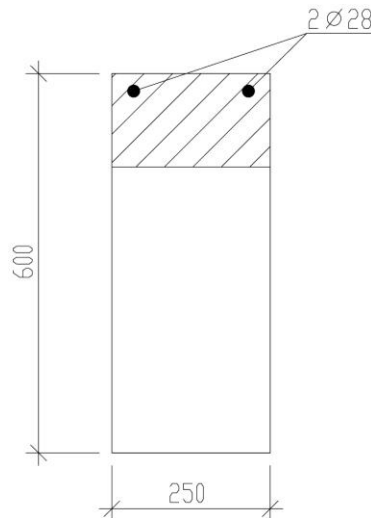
Армирование ригеля в сжатой зоне во 2-ом пролете
